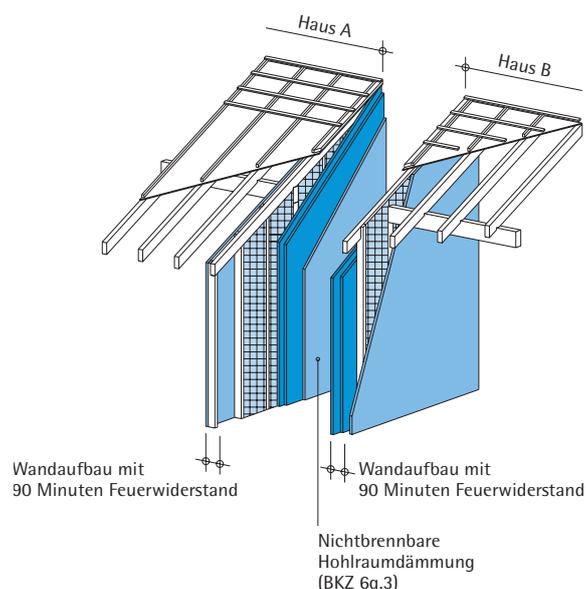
Schematische Darstellung einer zweischaligen Brandmauerkonstruktion in Holzbauweise
